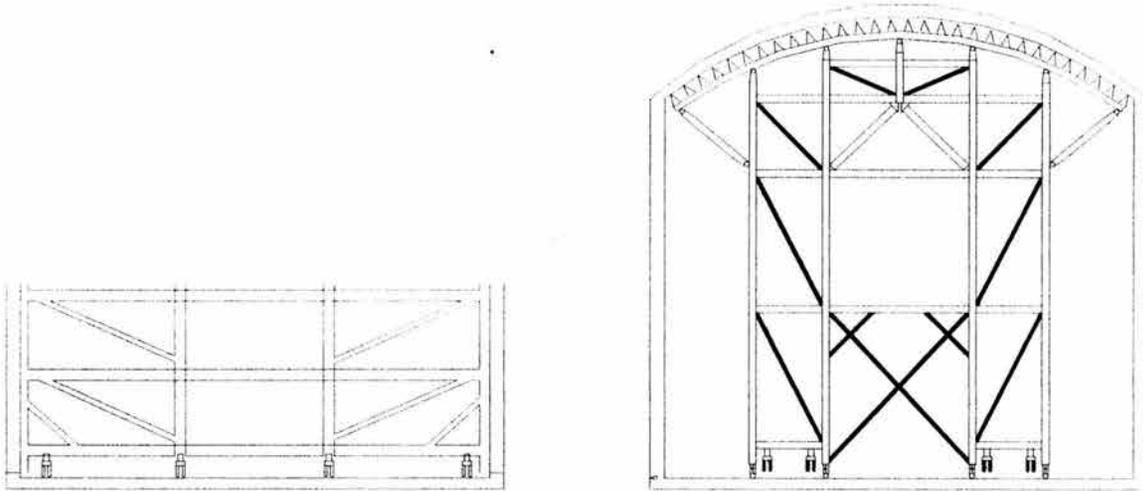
Jumbo para la Colocación del Concreto en la Bóveda.
